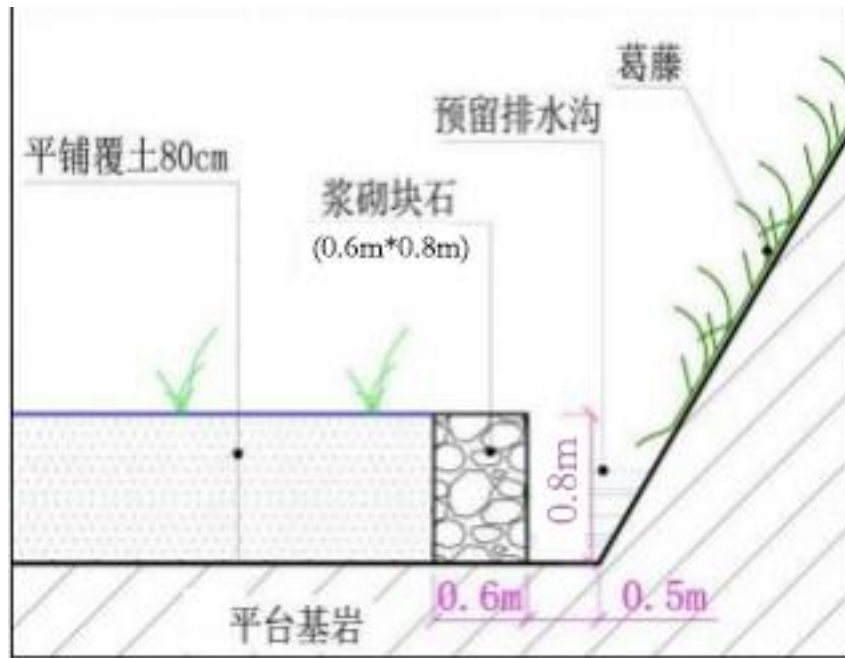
其他平台坡底石墙（排水沟）砌筑剖面图
